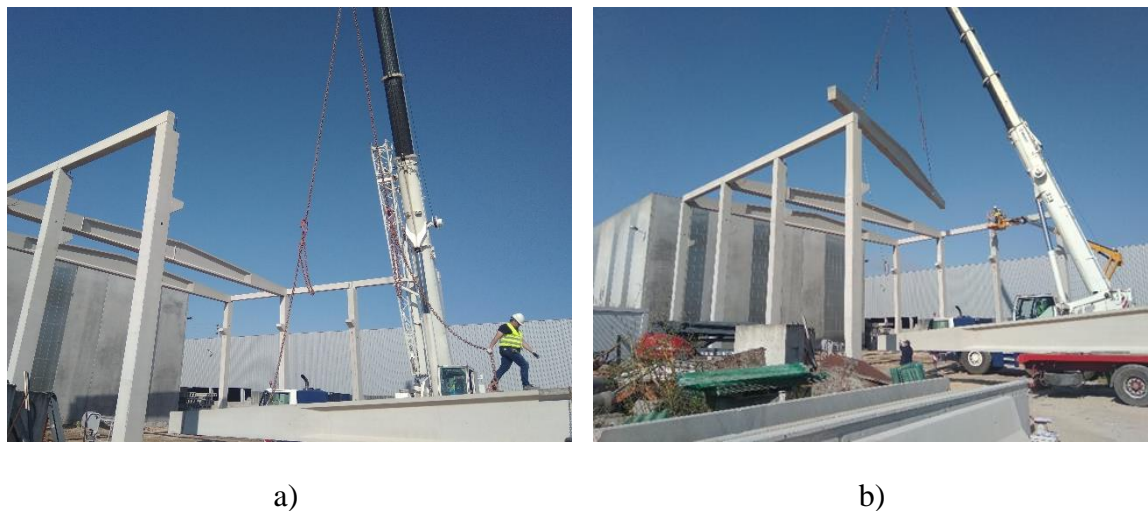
Pormenores montagem das vigas: a) Retirada da viga do camião; b) Montagem da viga
